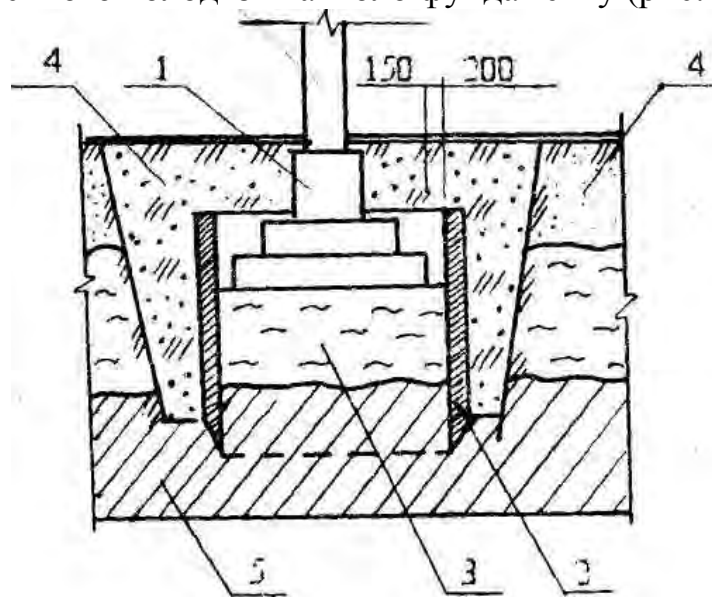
Улаштування опускного колодезя навкруги стовбчастого фундаменту:
